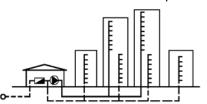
Схема параллельного зонирования системы водоснабжения микрорайона с разноэтажной застройкой: 1 – ввод; 2 – здание ЦТП; 3 и 4 – сети верхней и нижней зон
